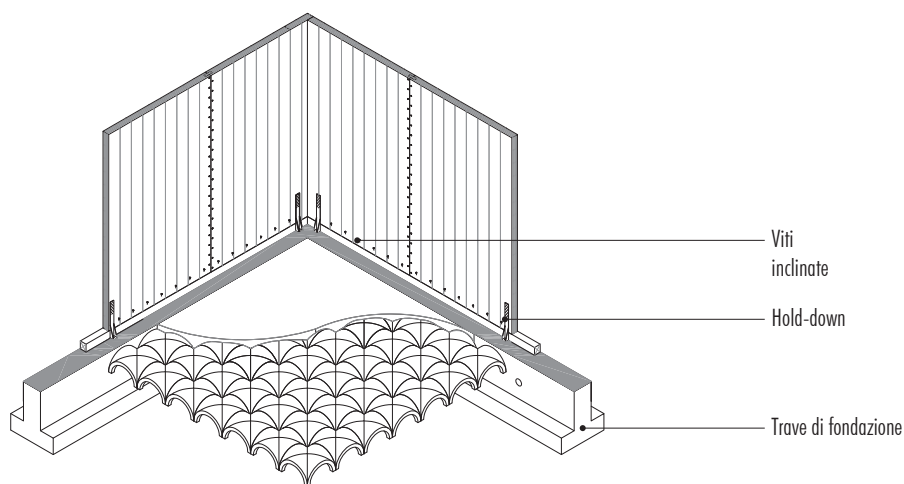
Collegamento alle fondazioni per un edificio XLam con cordolo di larice, tirafondi, viti e hold-down.
